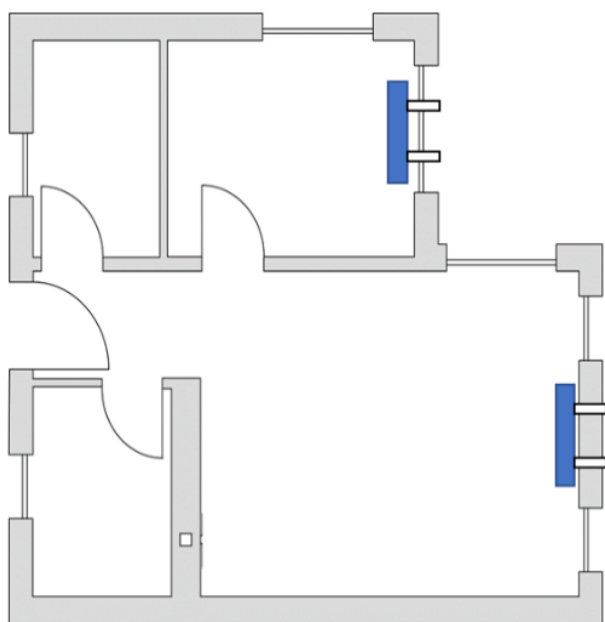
Beispielhafter Grundriss mit dezentralen, Kompakt-Luft-Wasser-Wärmepumpen über Außenwand
